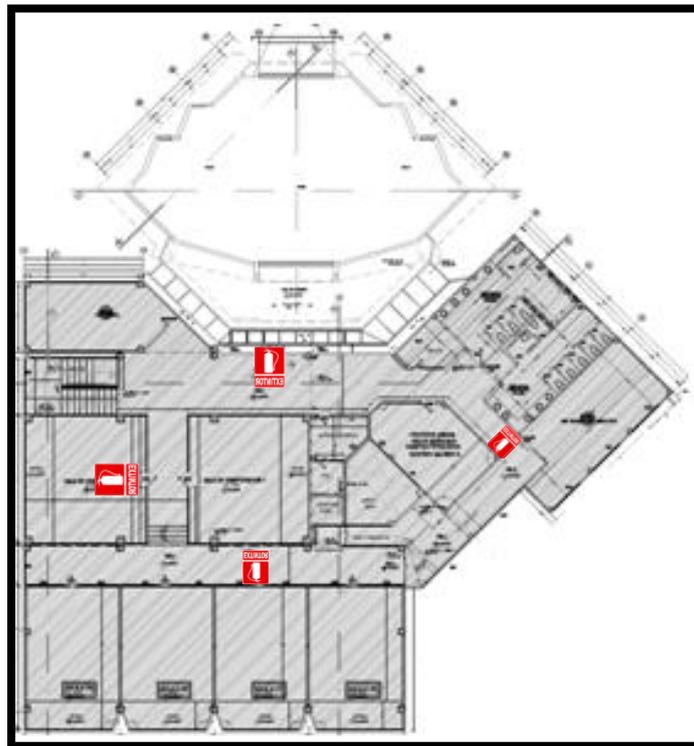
Extintores, Planta alta, Edificio 19-A, Zona 3
